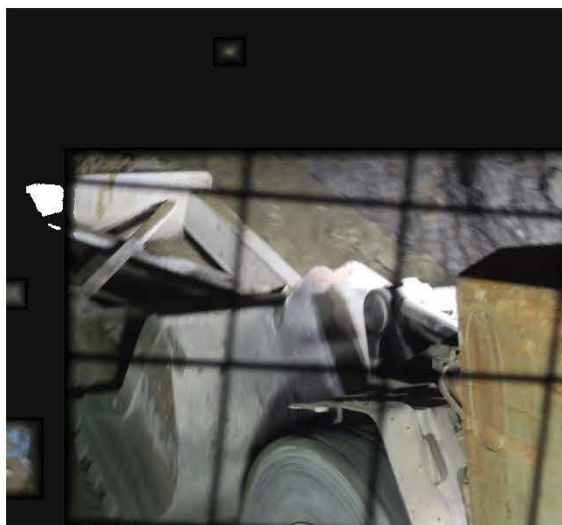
Utilisation d'une plaque de poussée placée dans un godet de chargeuse-navette (photo prise à la mine LaRonde).
